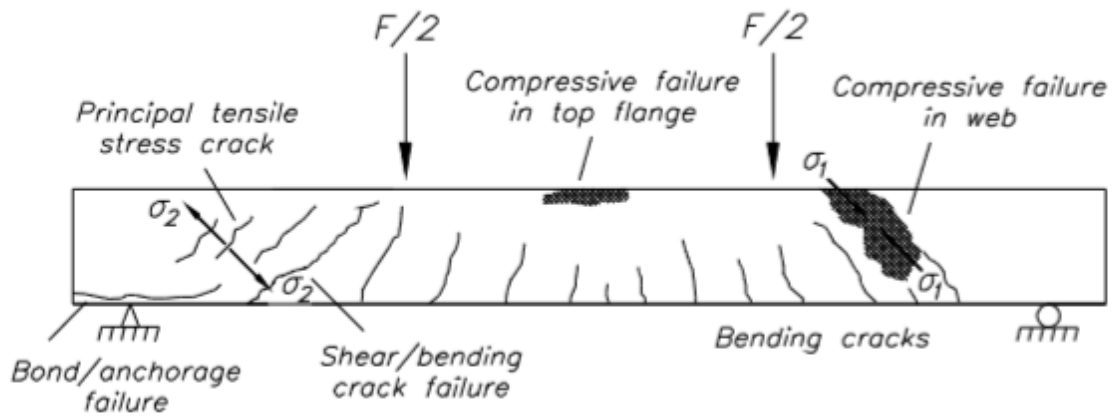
, Olika typer tvärkraftsbrott i betongbalk
